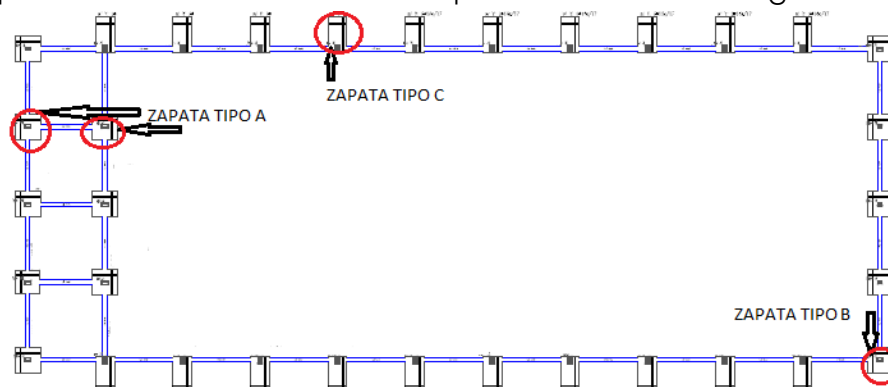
Disposición de los tres tipos de zapatas en la cimentación
